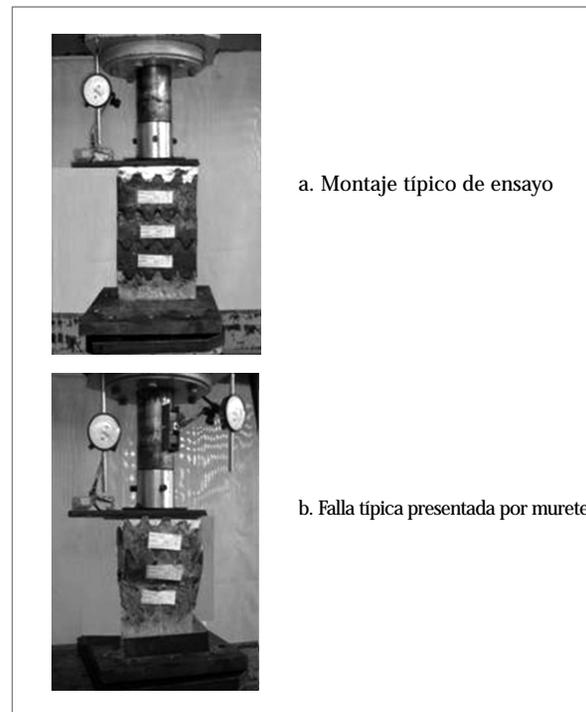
Ensayo a compresión típico ejecutado sobre murete
